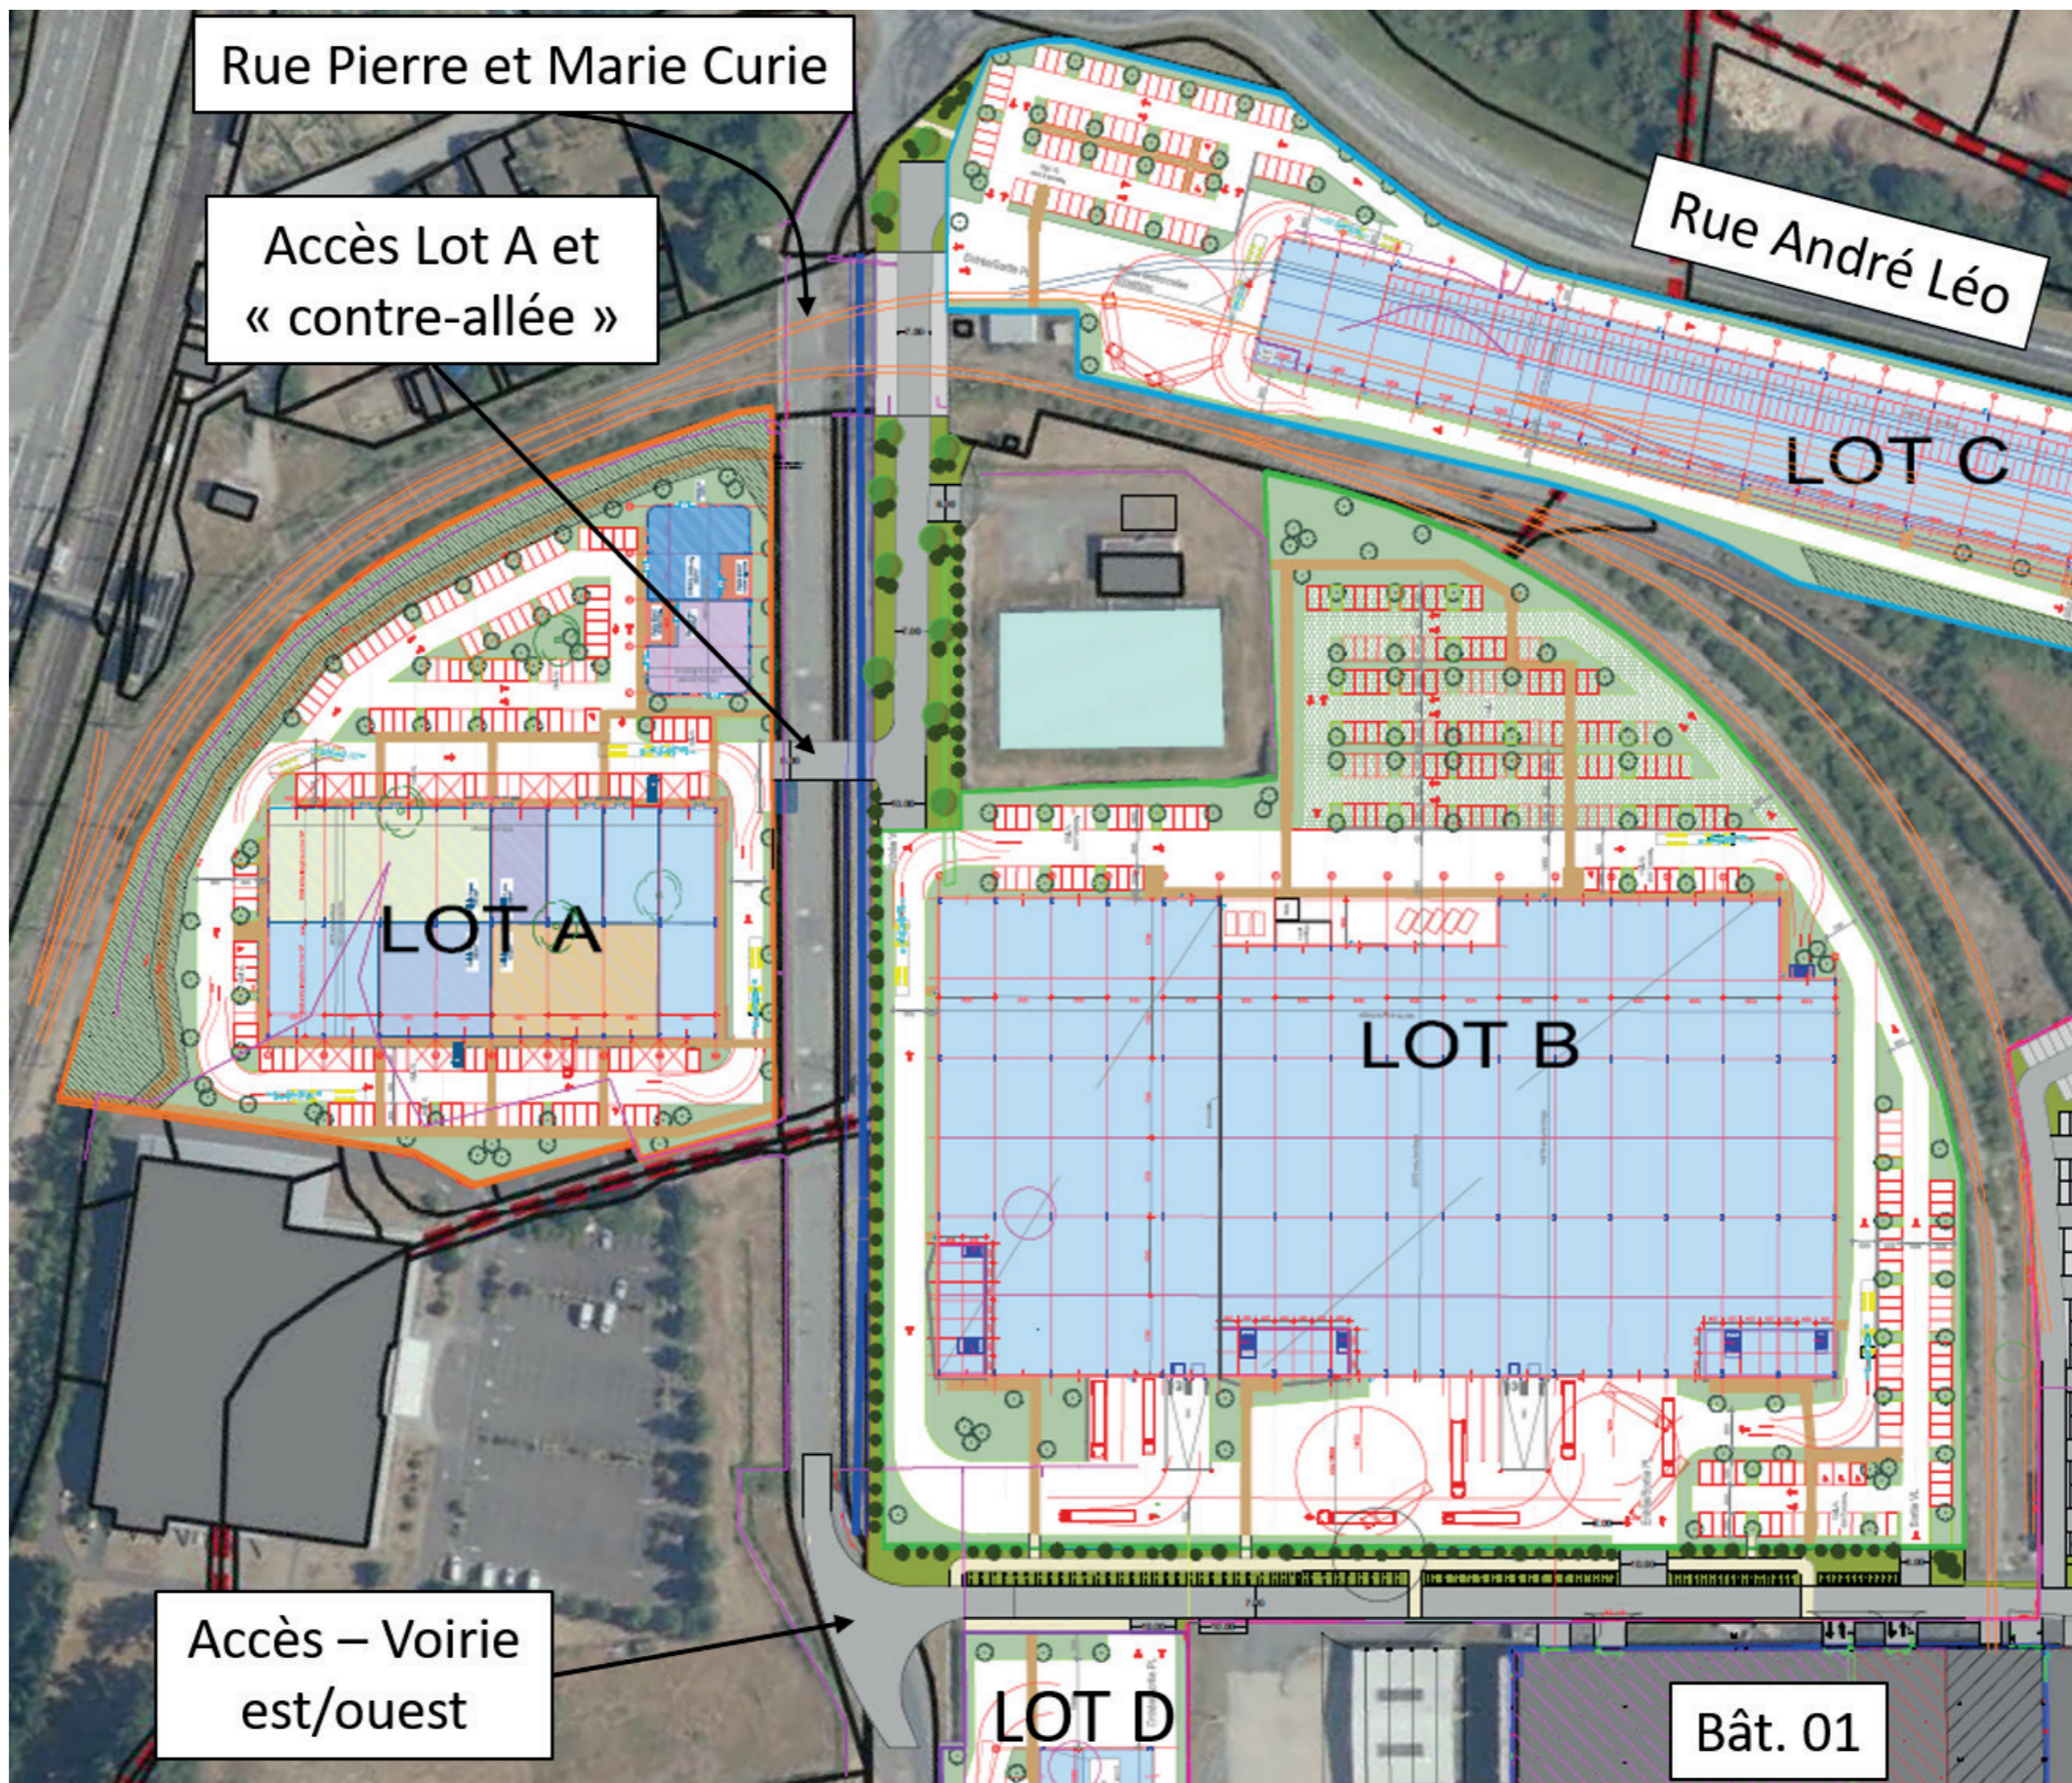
Plan masse du projet annoté - Zoom sur les accès
